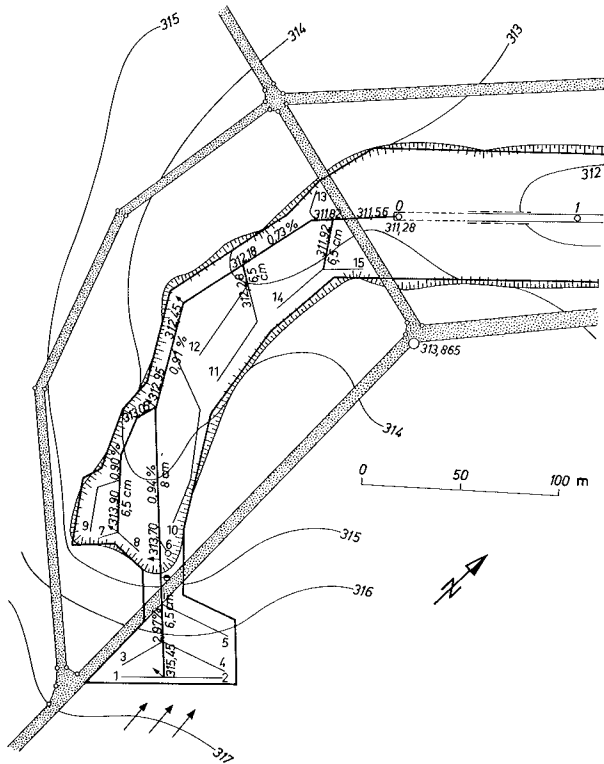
Lageplan für Rohrdränung eines Bachtals [7.31]
